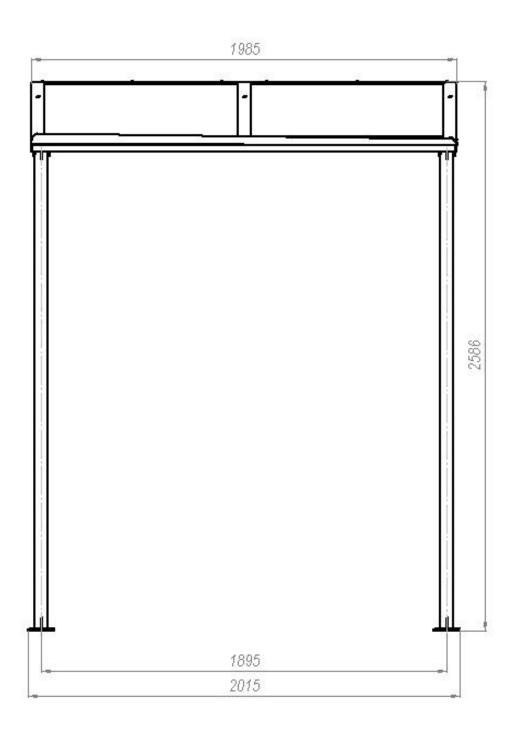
(б) – Габаритные размеры крыши (вид сбоку)
